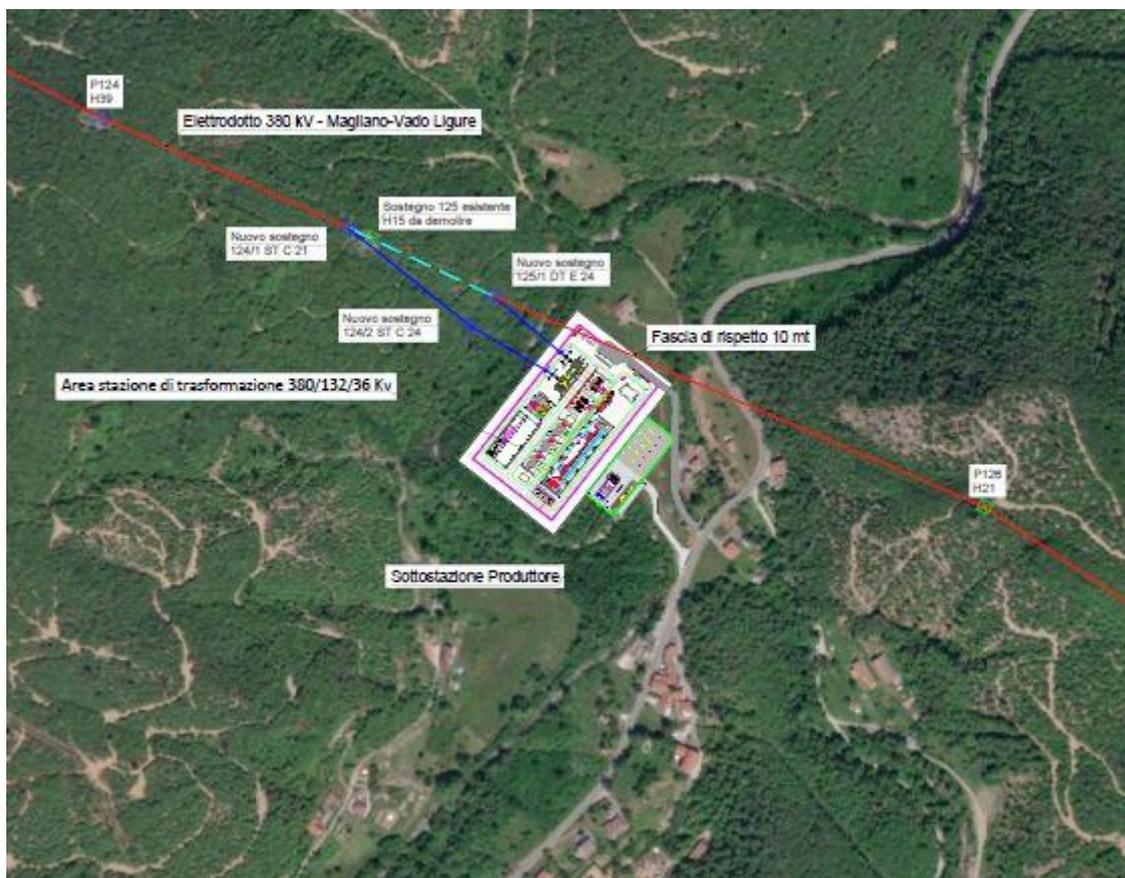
Ipotesi della pianta elettromeccanica della stazione 380/132/36 kV su ortofoto
